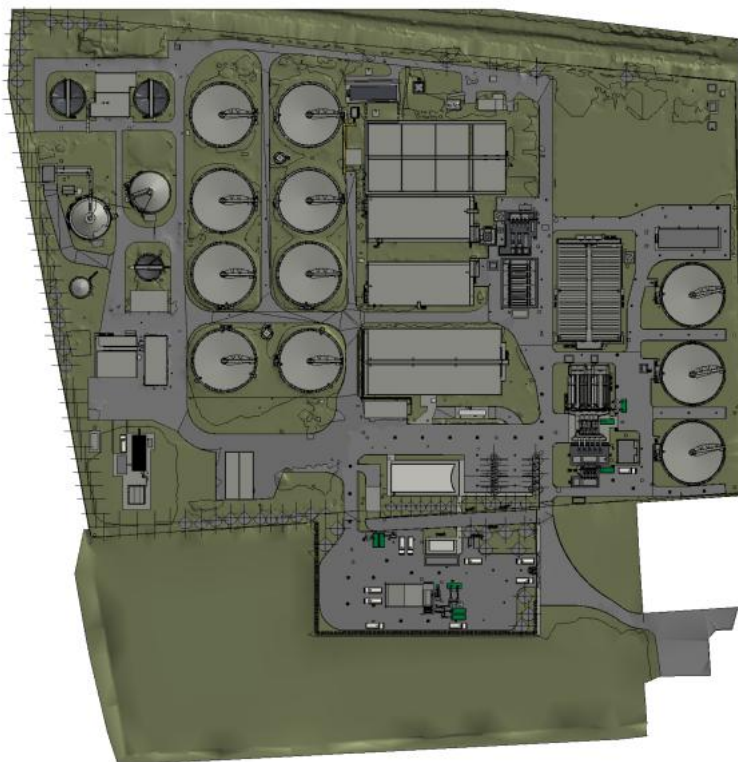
Layout stato di progetto impianto di depurazione di Ravenna
